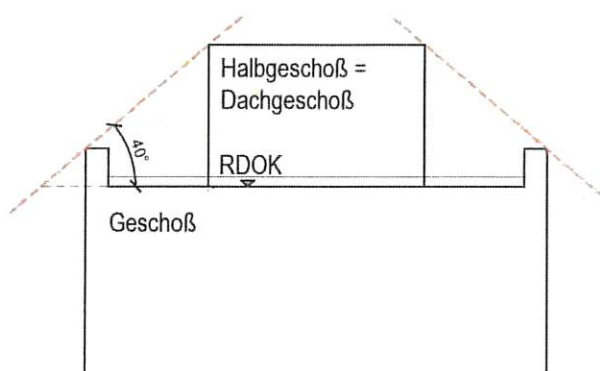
Skizze zur Festlegung des Dachgeschoßes
